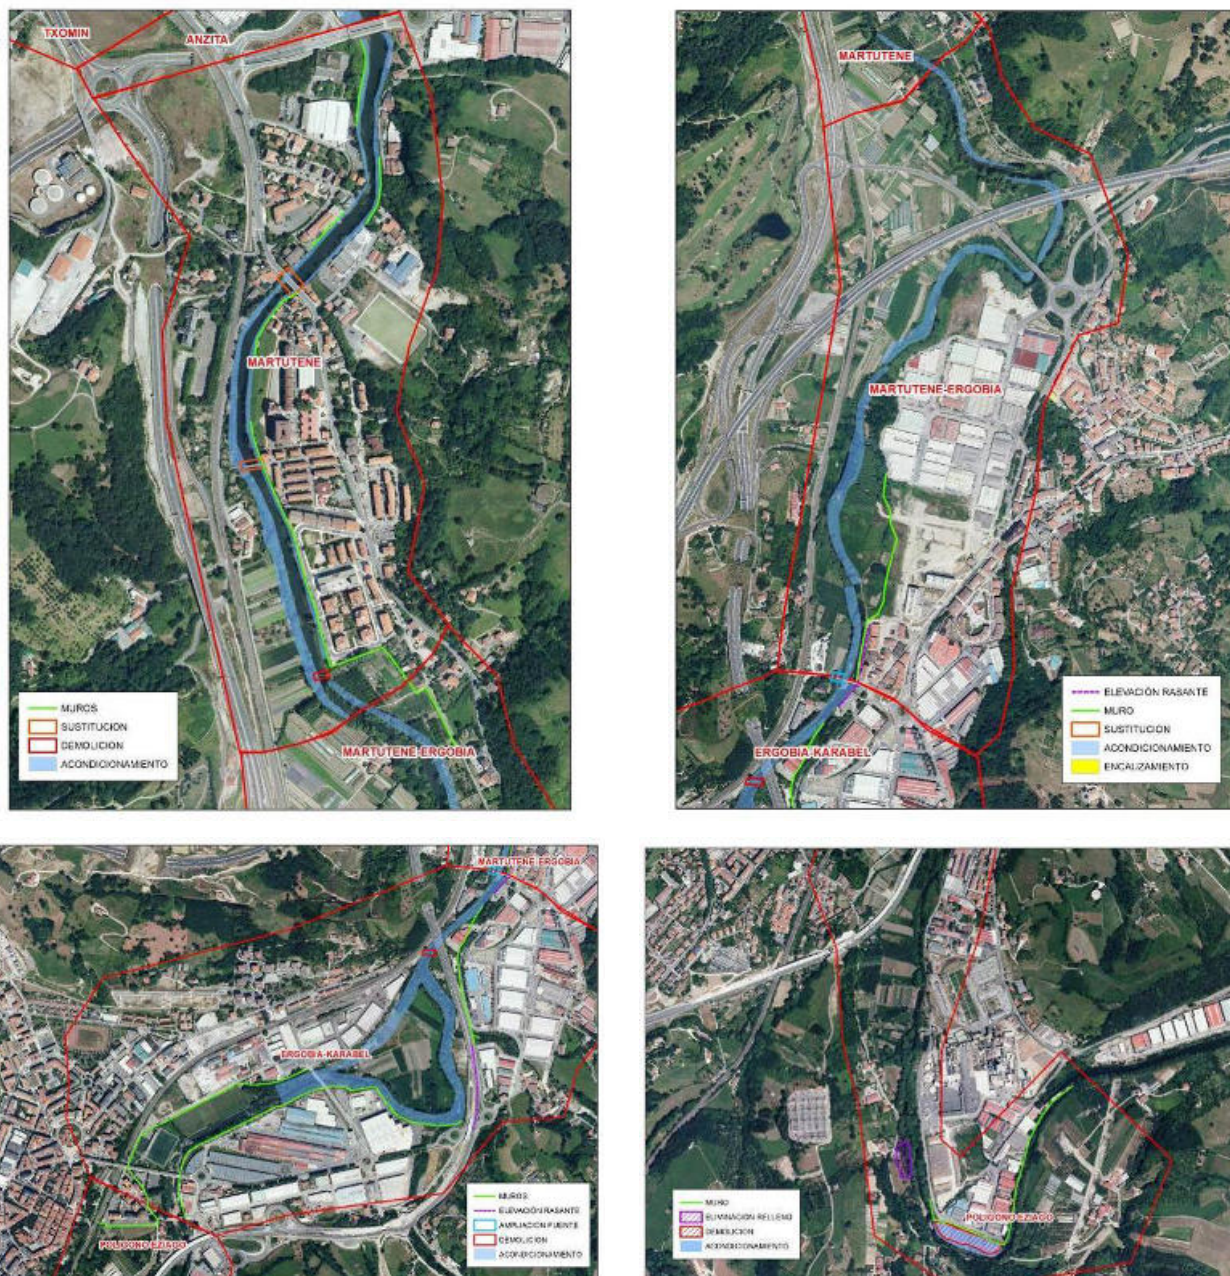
Planta de actuaciones planteadas por ámbito. ARPSI de Urumea
